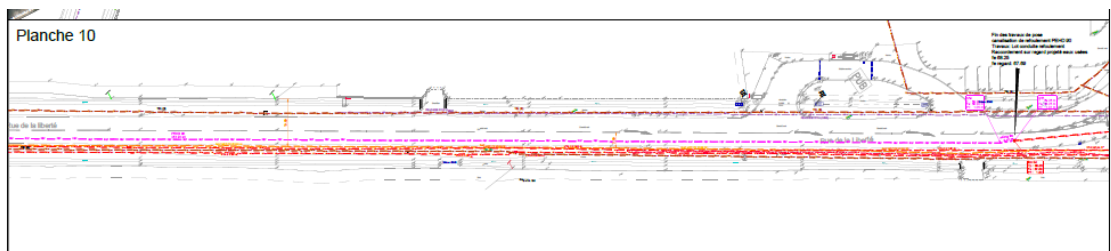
Vue en plan du tracé du projet de conduite de refoulement – Planche 10 (Source : Elcimai Environnement - PRO)
